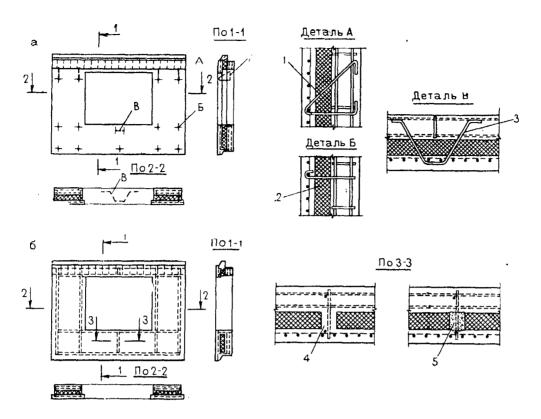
Связи бетонных слоев в трехслойных панелях a — схема расположения детали гибких связей; δ — то же, жестких связей; l — подвеска; l — распорка; l — подкос; l — ребро из бетона внешних слоев; l — легкобетонное ребро
